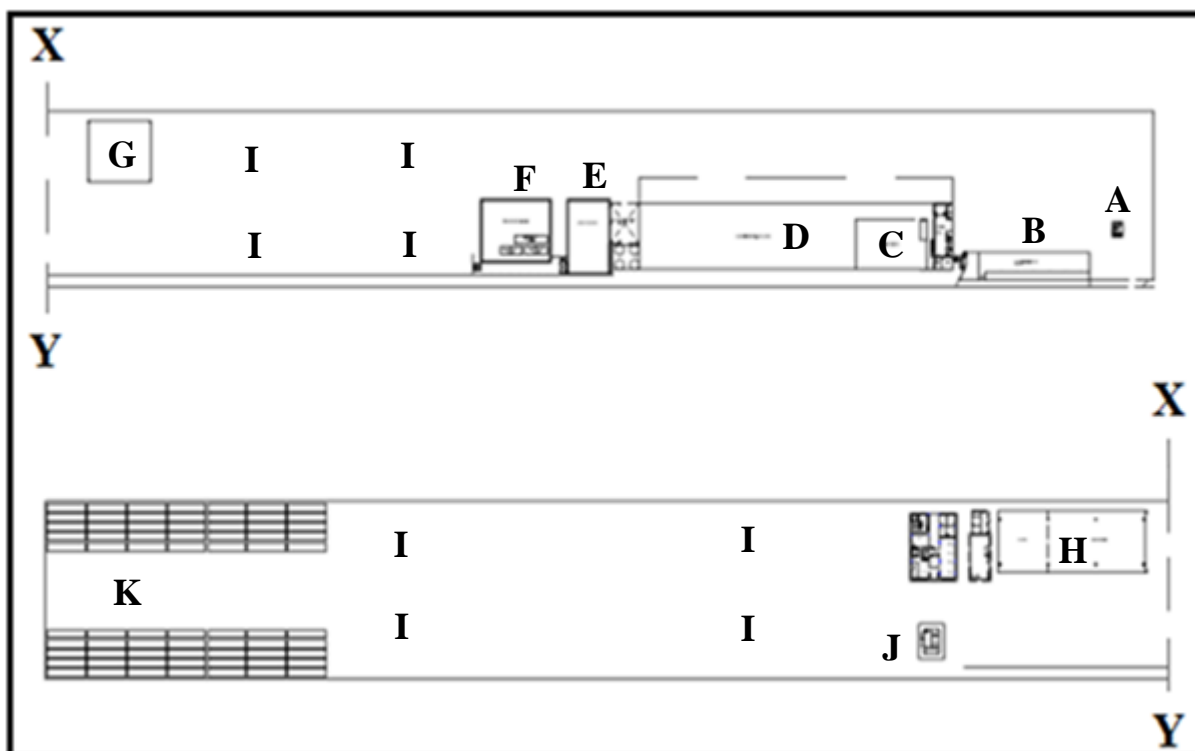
Planta esquemática do Empreendimento com seus setores operacionais (ver legenda abaixo).
